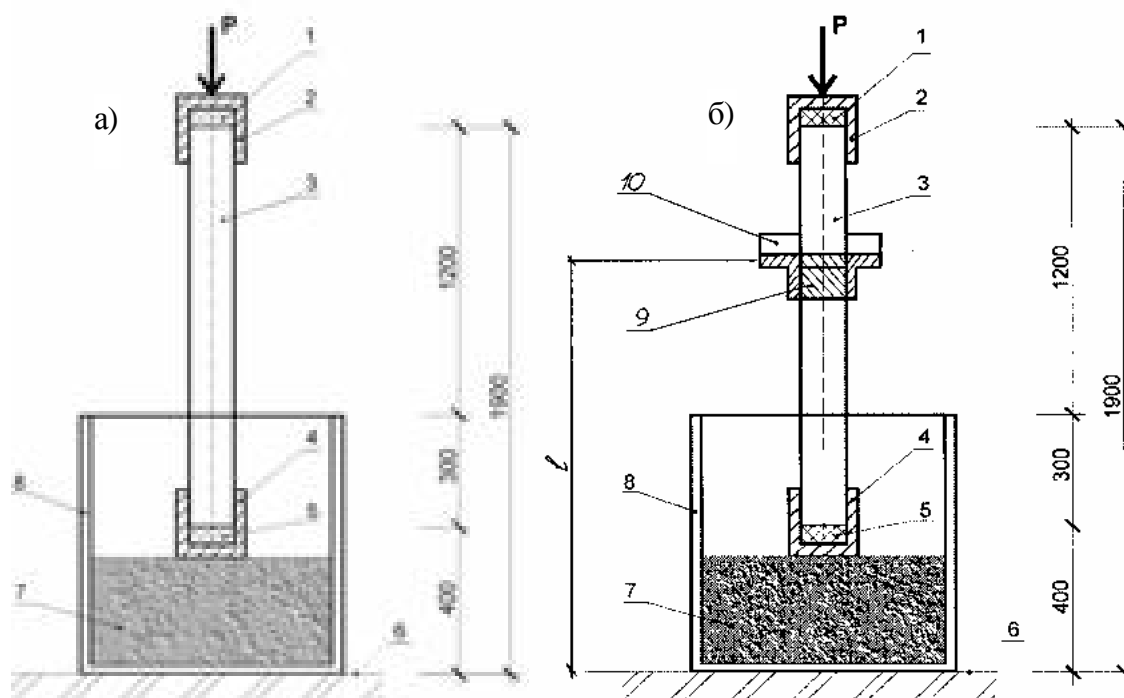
Схема испытания образцов: а – соответствующая начальному этапу погружения свай; б – с учетом присоединенной массы: 1 – прокладка наголовника; 2 – наголовник; 3 – свая; 4 – нижний стакан; 5 – прокладка; 6 – железобетонный массив; 7 – щебень; 8 – металлический короб; 9 – металлическая обойма; 10 – изменяемый груз
